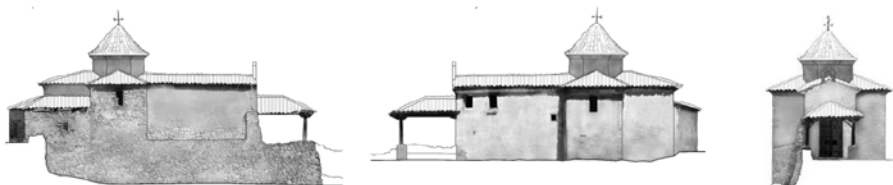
Montaje de los fotoalzados Oeste, Este y Sur tras finalizar las tres fases de intervención. Fuente propia
